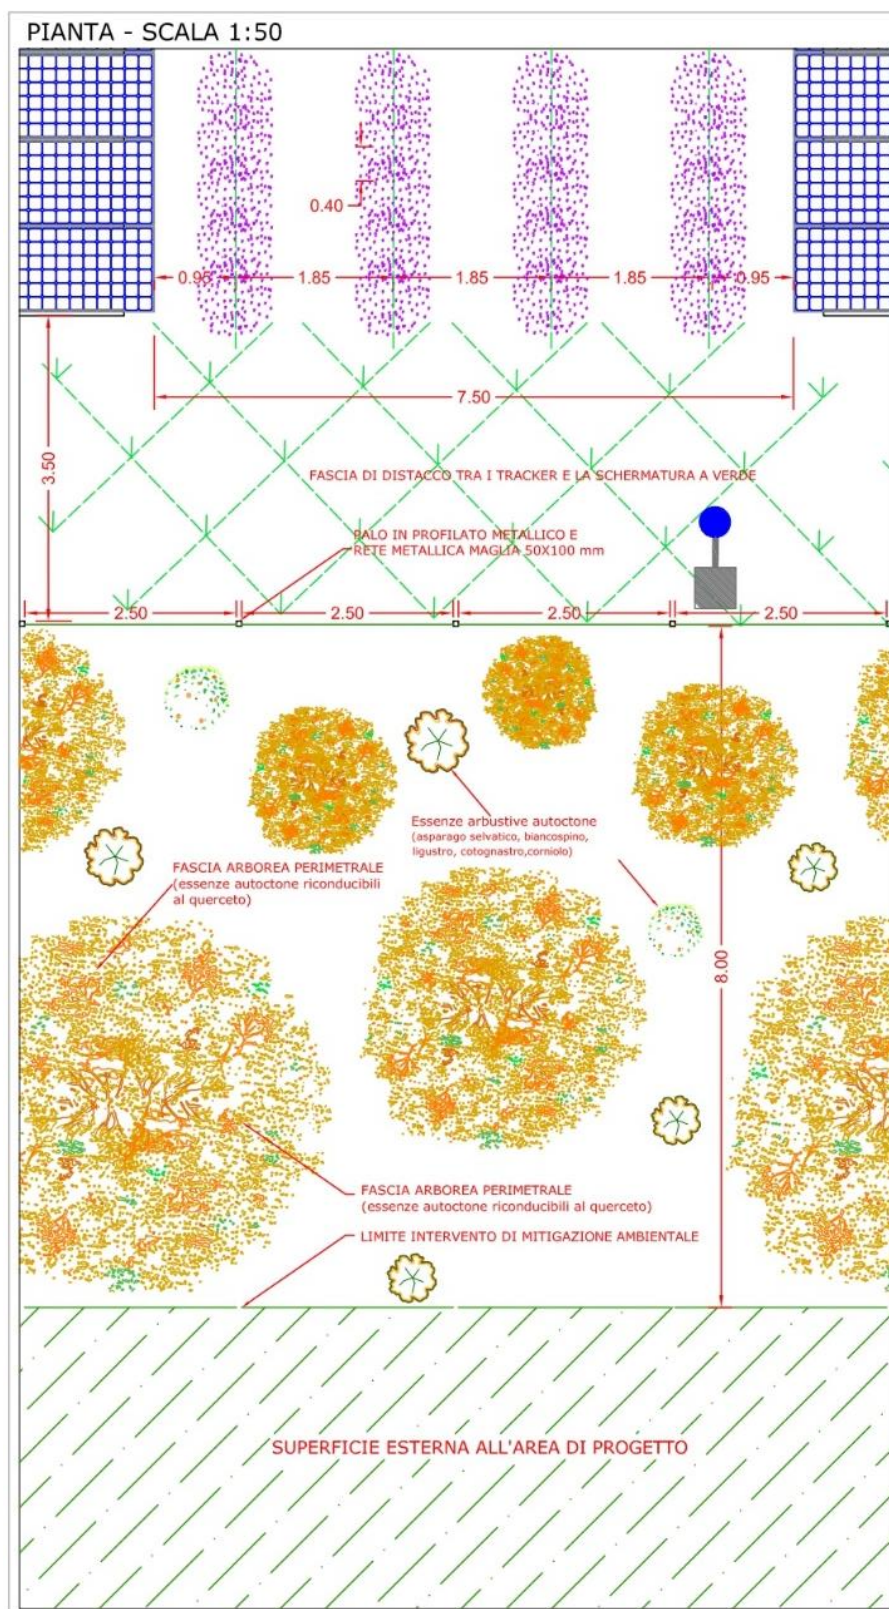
sistemazione paesaggistica dell'area lungo il perimetro impianto – planimetria con la definizione delle schermature a verde con essenze autoctone (arboree ed arbustive) in rapporto alla sistemazione interna al campo ed al rapporto tracker-piantagione agricola.
